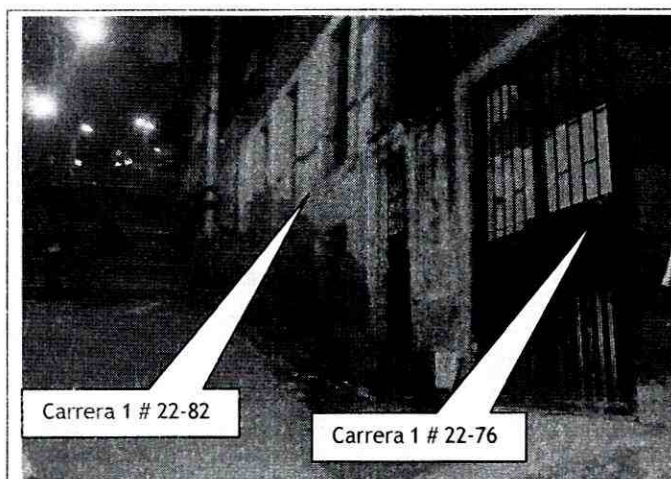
Vista general de los muros de cerramiento del costado sur de la vivienda emplazada en el predio de la carrera 1 # 22-82, muros en los que se identifica un alto grado de deterioro y pudrición.
